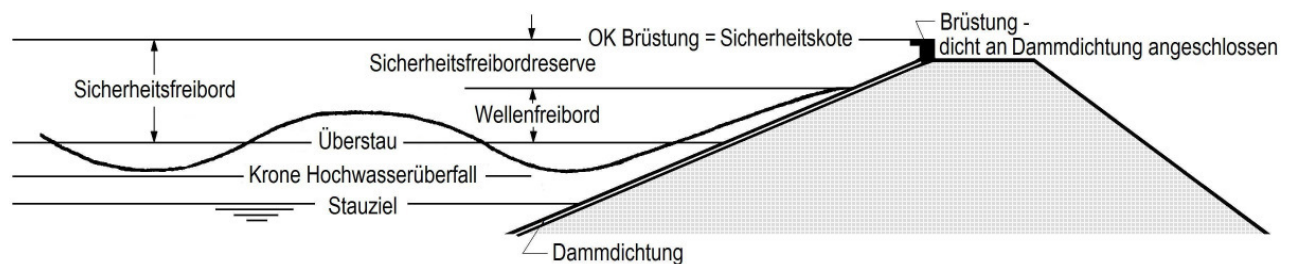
Definitionsskizze Staudamm mit Brüstungsmauer und Oberflächendichtung
